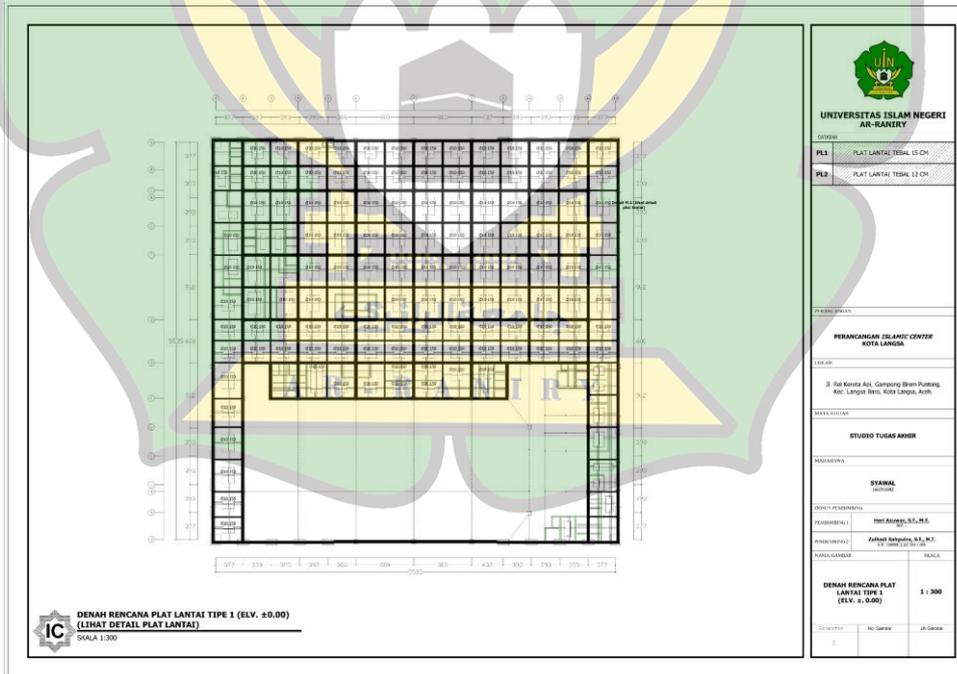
Denah Rencana Plat Lantai Tipe 1 (ELV. -1.00)
